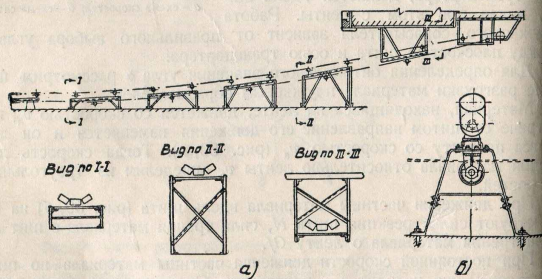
Станины транспортера (продольный вид и поперечные разрезы)
